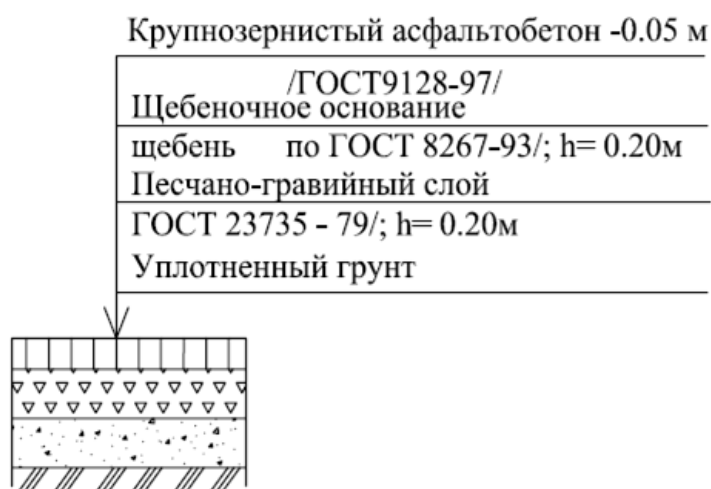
Конструкция временных автодорог с твердым, асфальтобетонным покрытием
